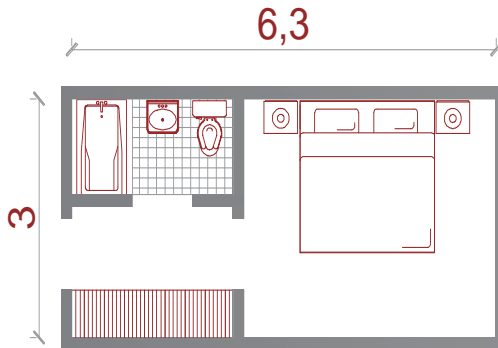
/ Planta habitación tipo de 20m² a 23m²¹²⁷
